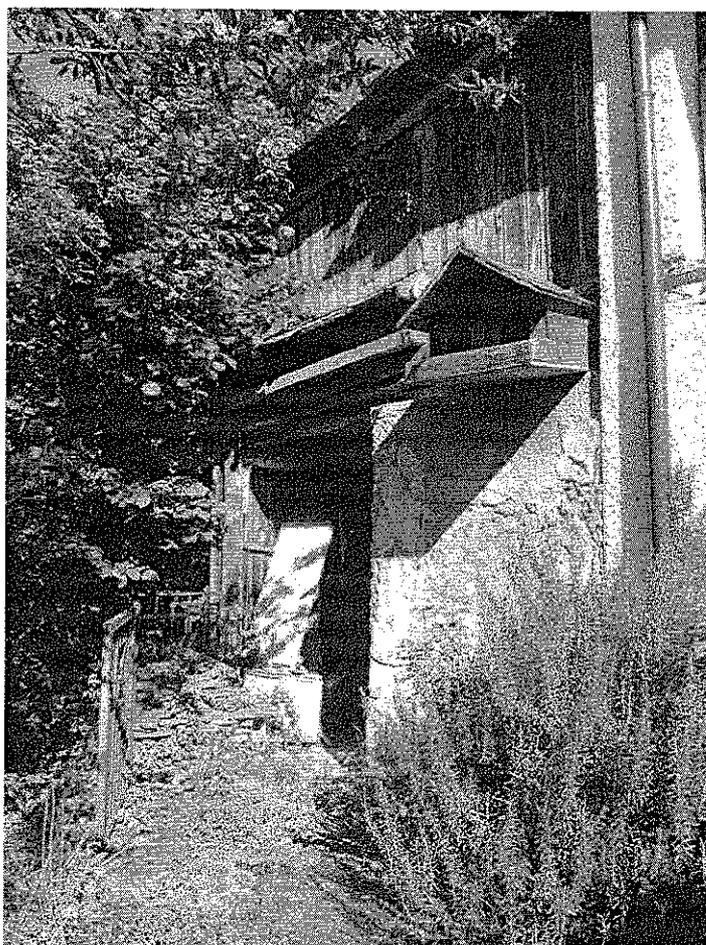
portico con accesso alla centrale termica al piano terra e granaio al piano primo
